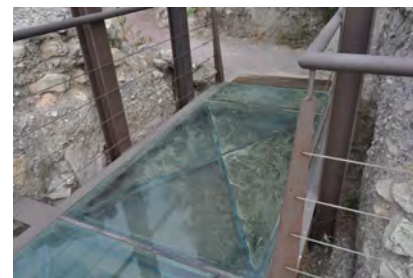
Crecimiento de vegetación bajo el pavimento de vidrio. (Foto: Julia García, 2013)
